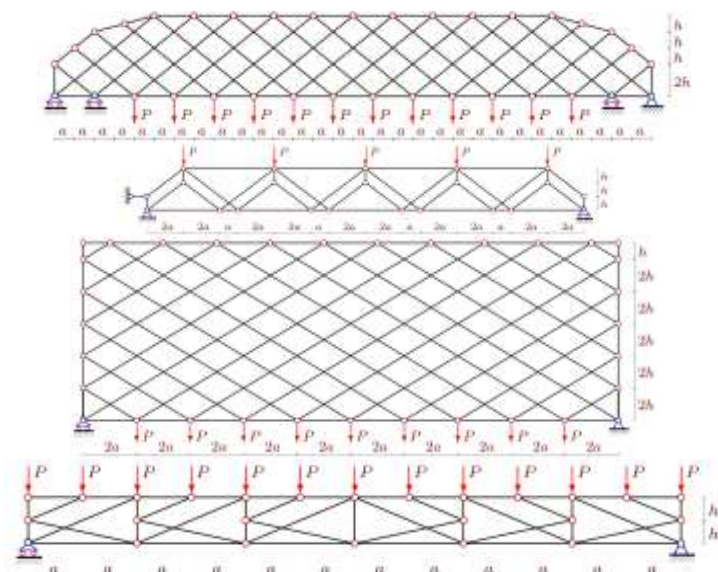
Плоские статически определимые фермы с дополнительными опорами, сложной или нестандартной решеткой
